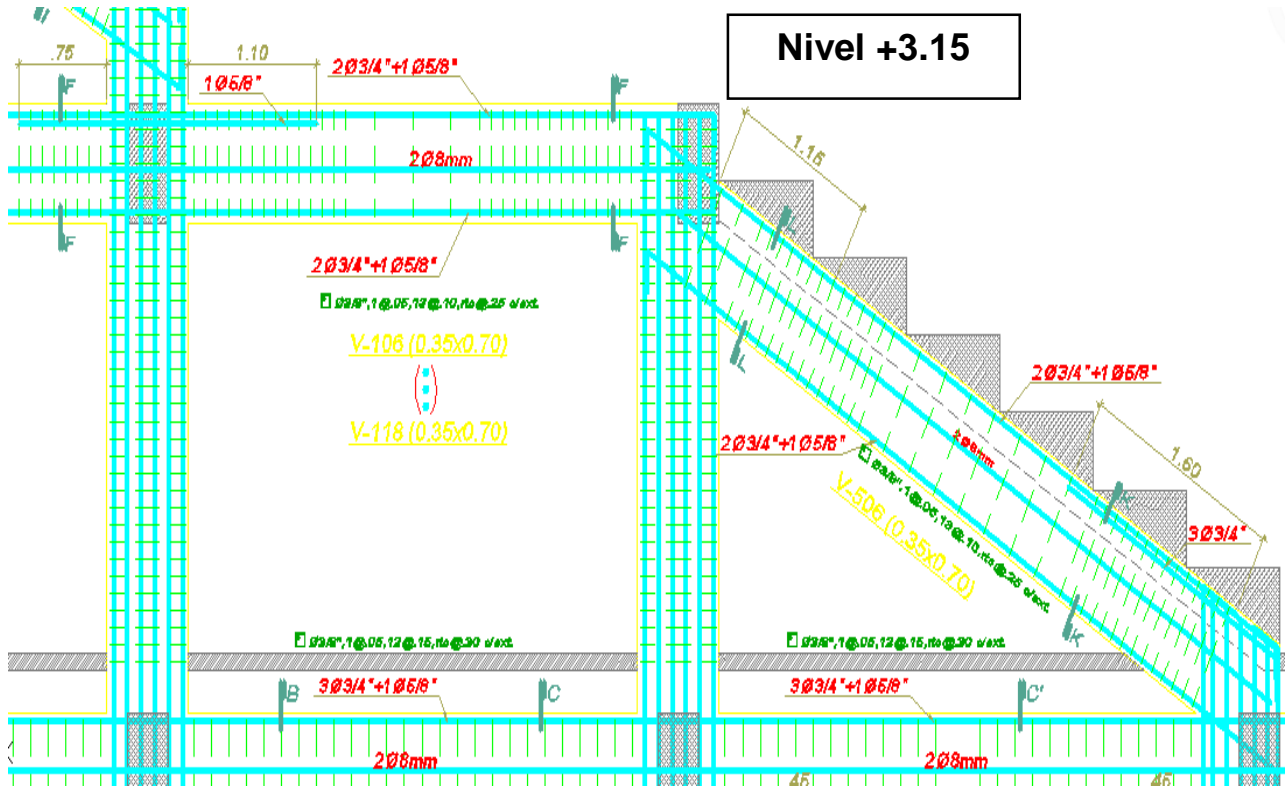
Cortado del refuerzo en vigas del eje 2 (Nivel +3.15m)
